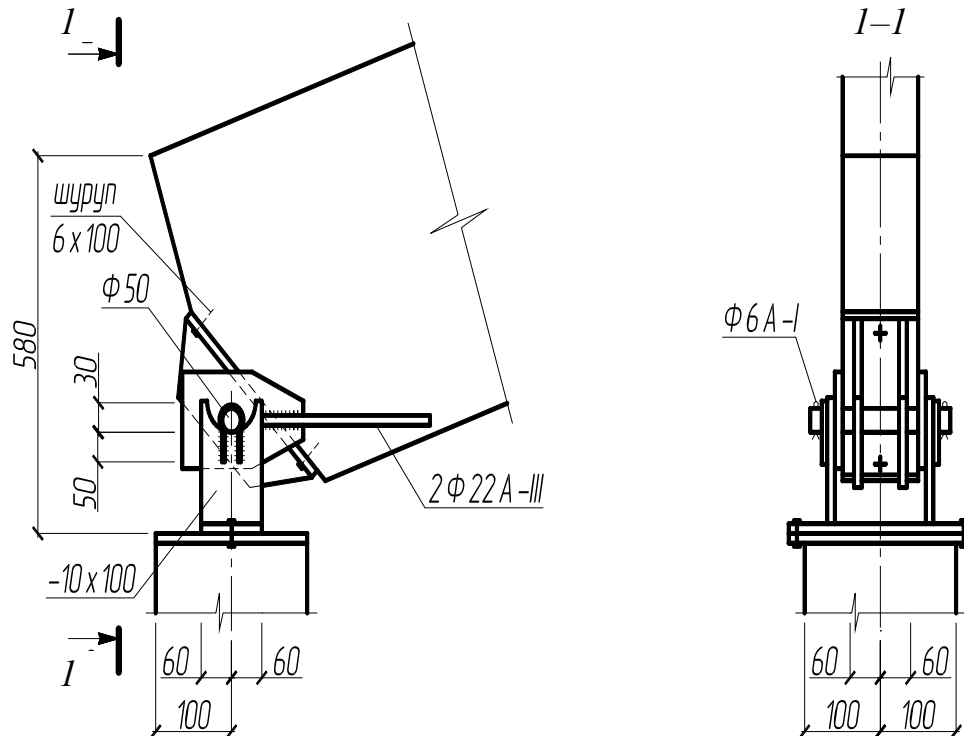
Опорный узел треугольной арки с клееным армированным верхним поясом
